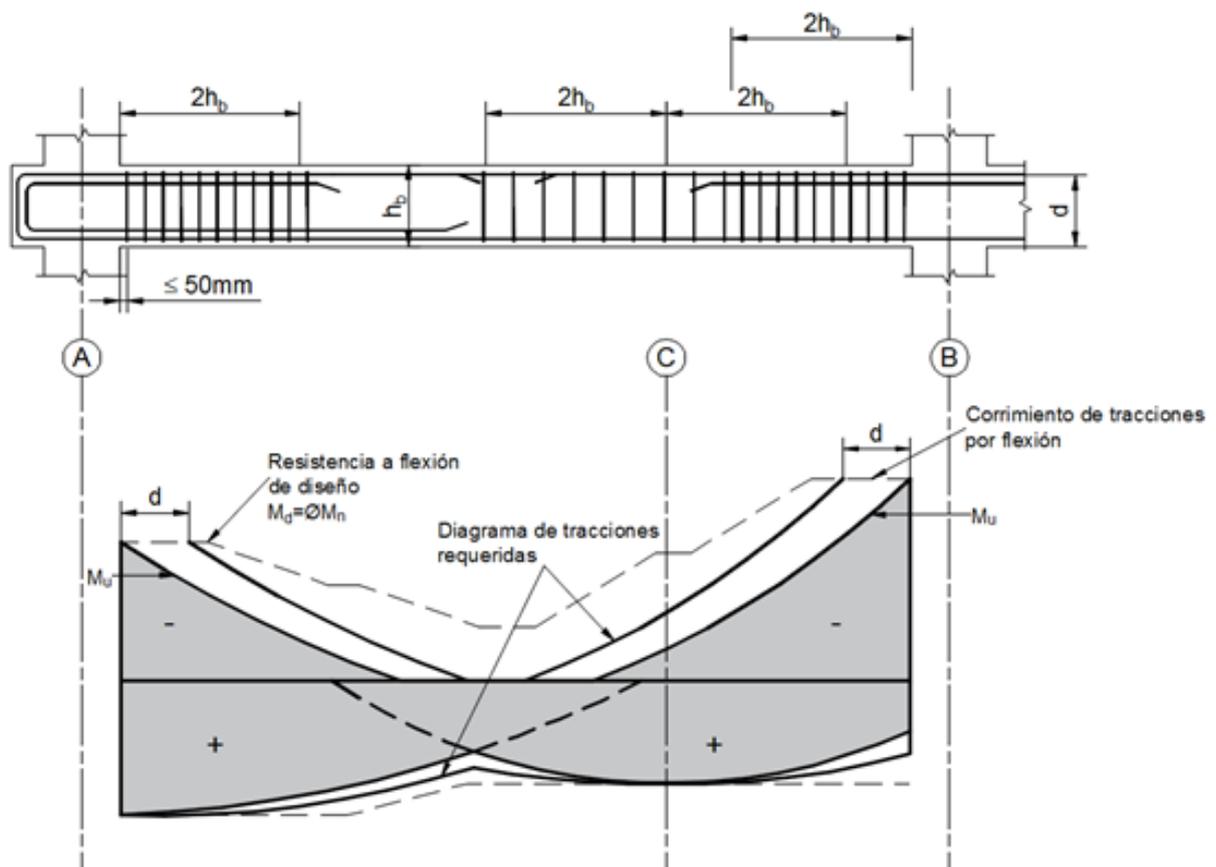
Longitud de las zonas potenciales de rótulas plásticas cuando la sección crítica se ubica en la cara del apoyo y en el tramo de la viga.
